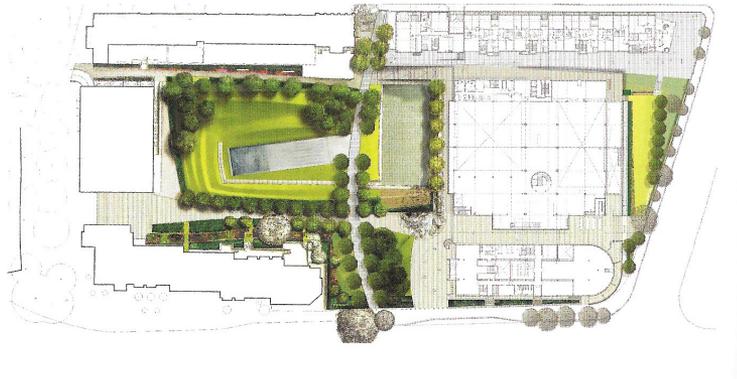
Espacio abierto de Swiss Cottage, Londres, 2006: planta general.
